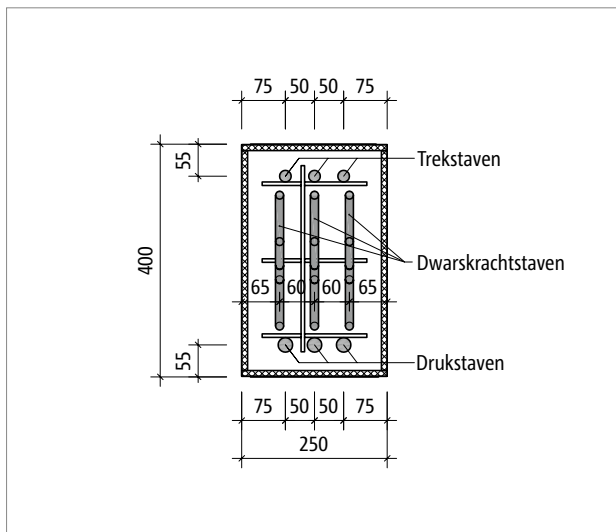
Schöck Isokorf® T type B-M5-V2 in hoogte H400: Zijaanzicht
